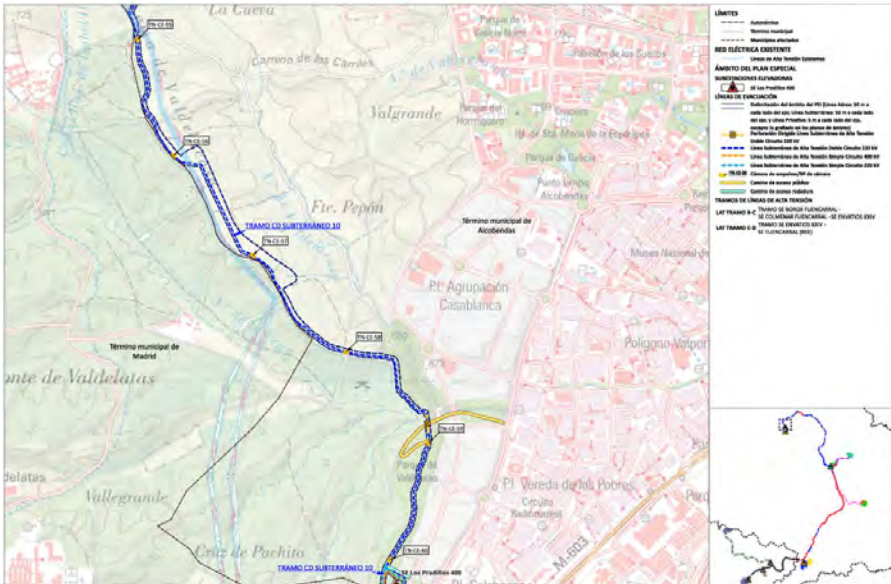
Plano de Ordenación O2.5.14. Planta por tramos. LASAT Promotores Nudo Fuencarral Tramo C-D
